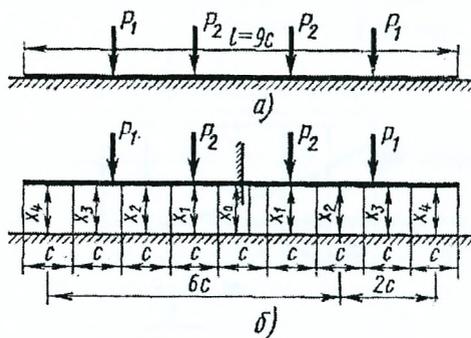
К расчету балок по методу Б. Н. Жемочкина
